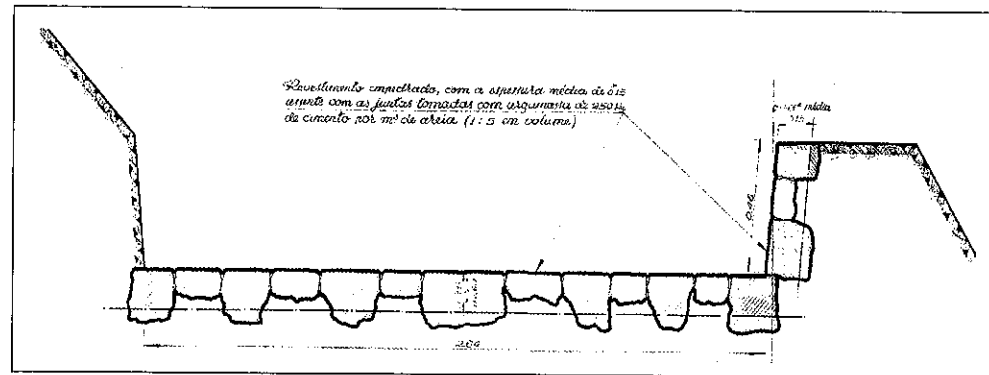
Perfil transversal do canal de Este e das obras previstas para a sua reconstrução (1941).
